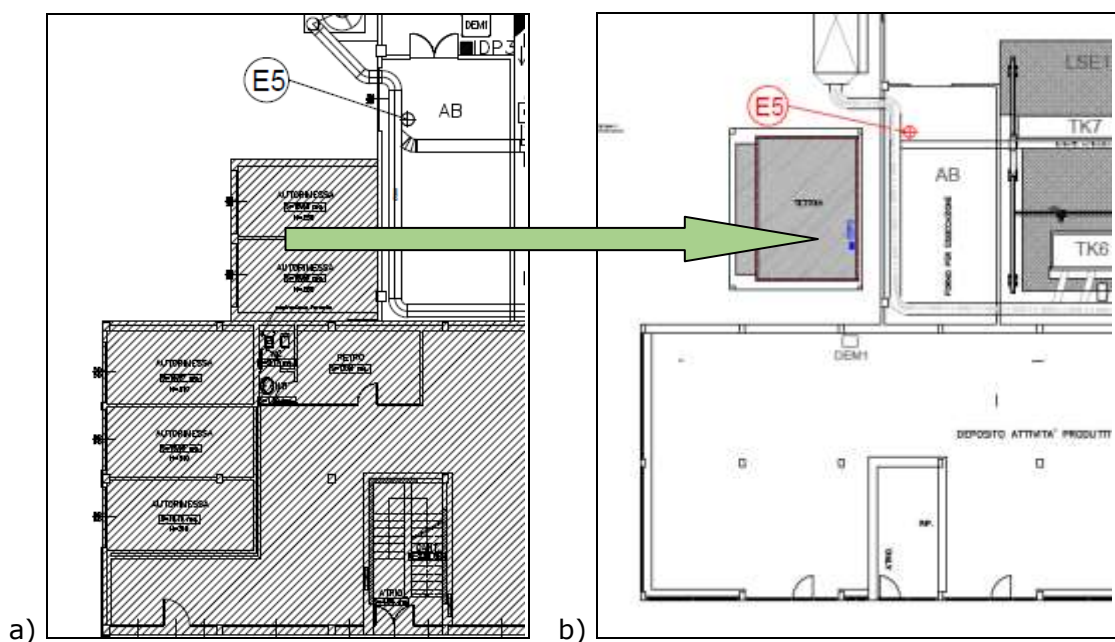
Stralci della planimetria stato attuale (a) e stato di progetto (fonte: geom. Brugnoli Adriano) (b)
